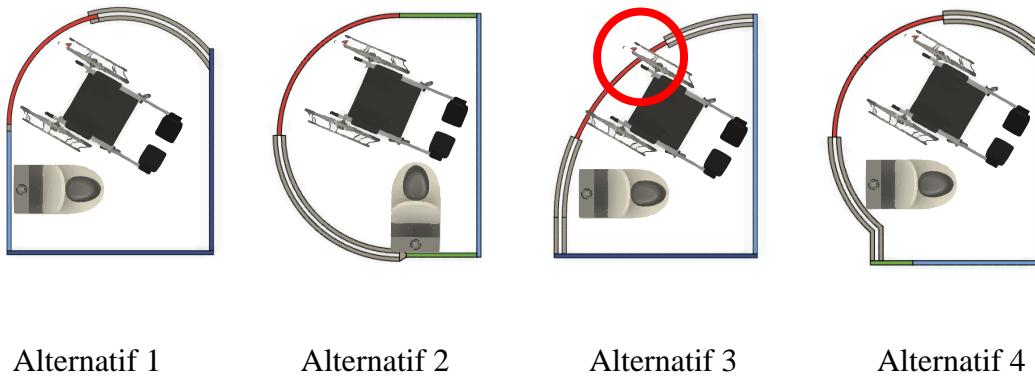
Alternatif 4 Konfigurasi Panel *Universal Lavatory Module
